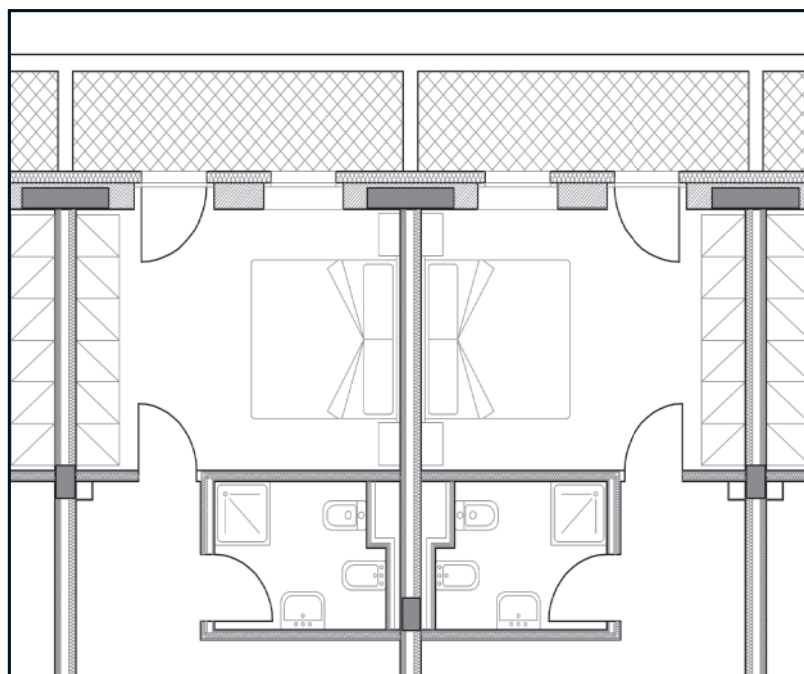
Pianta degli ambienti oggetto delle misurazioni.
